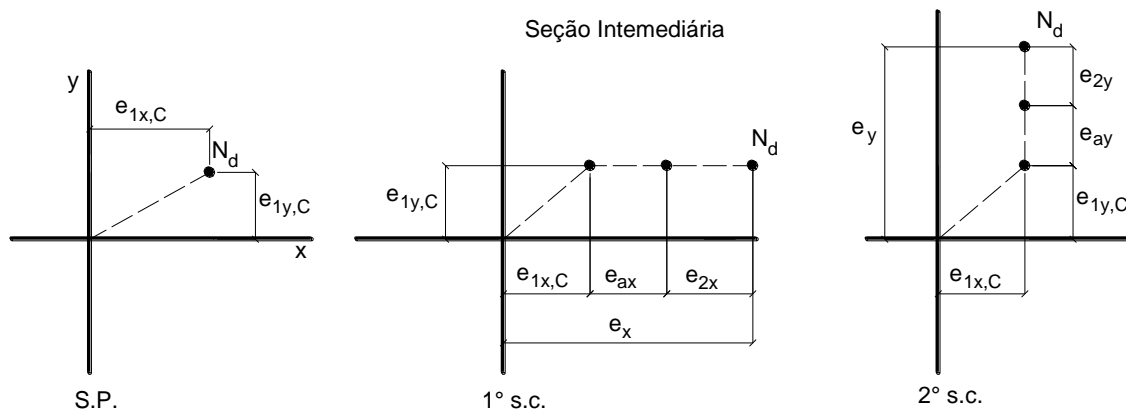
Situação de projeto e situações de cálculo para a seção intermediária do pilar de canto.
